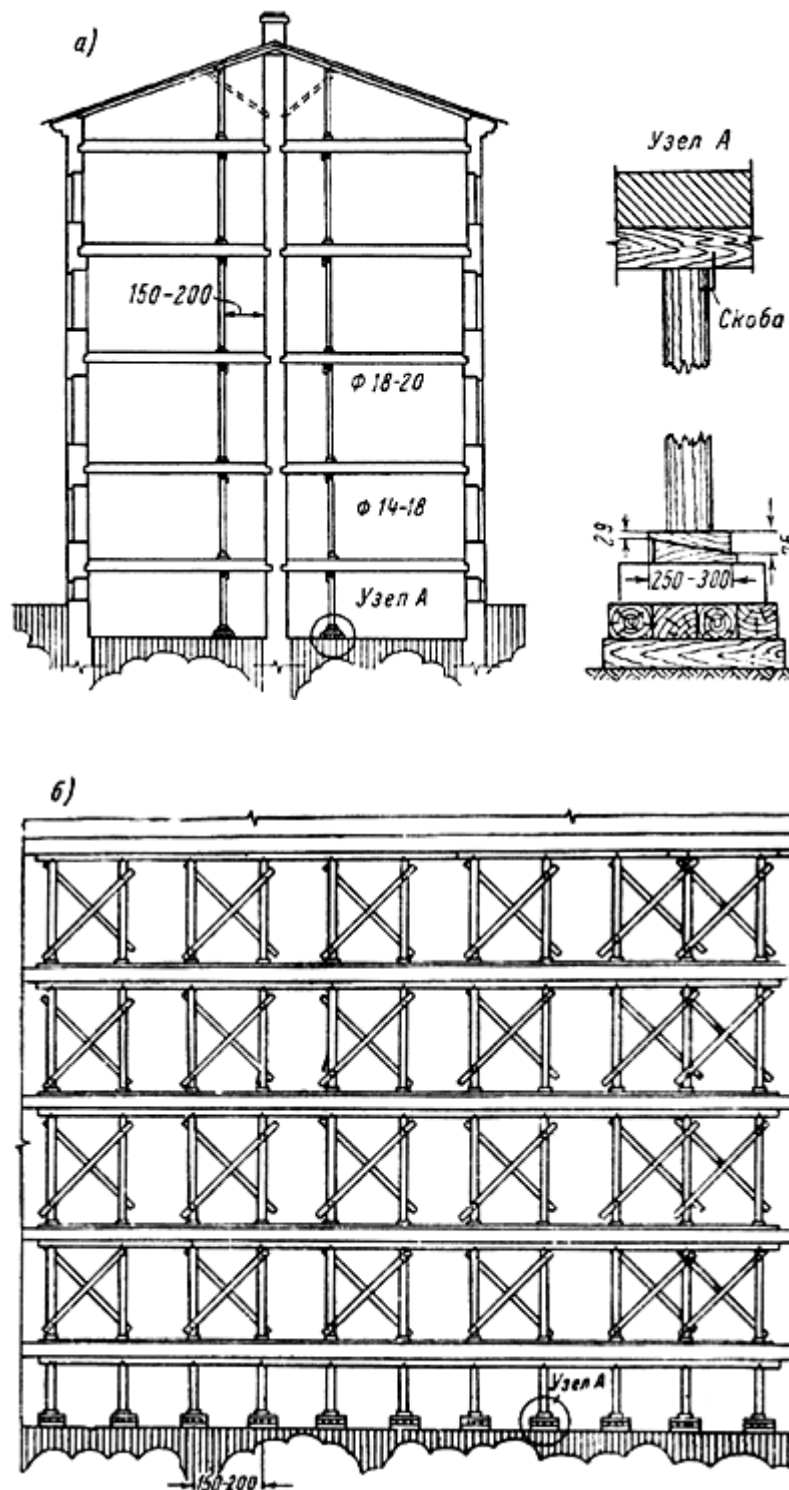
Установка временных креплений при перекладке участка средней продольной стены с сохранением существующих перекрытий
